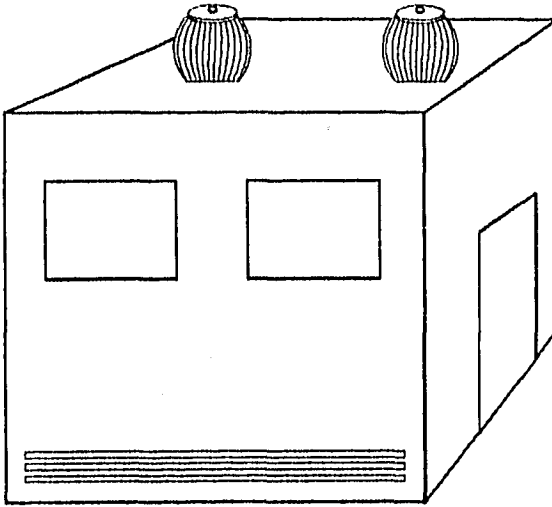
Planta de Destete con el Sistema de Extracción de Aire.
